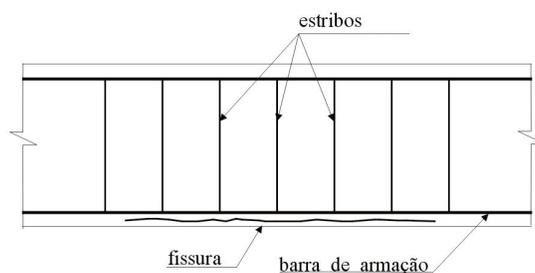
Fissuras causadas pela corrosão das armaduras
